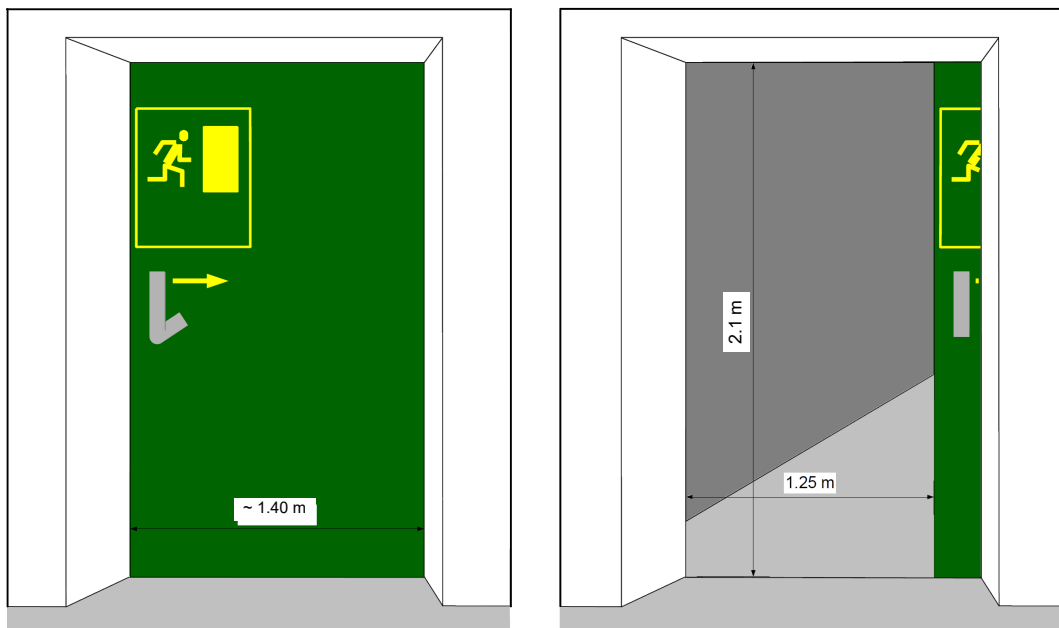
Dimensions des portes de chemin de fuite, type porte coulissante.
